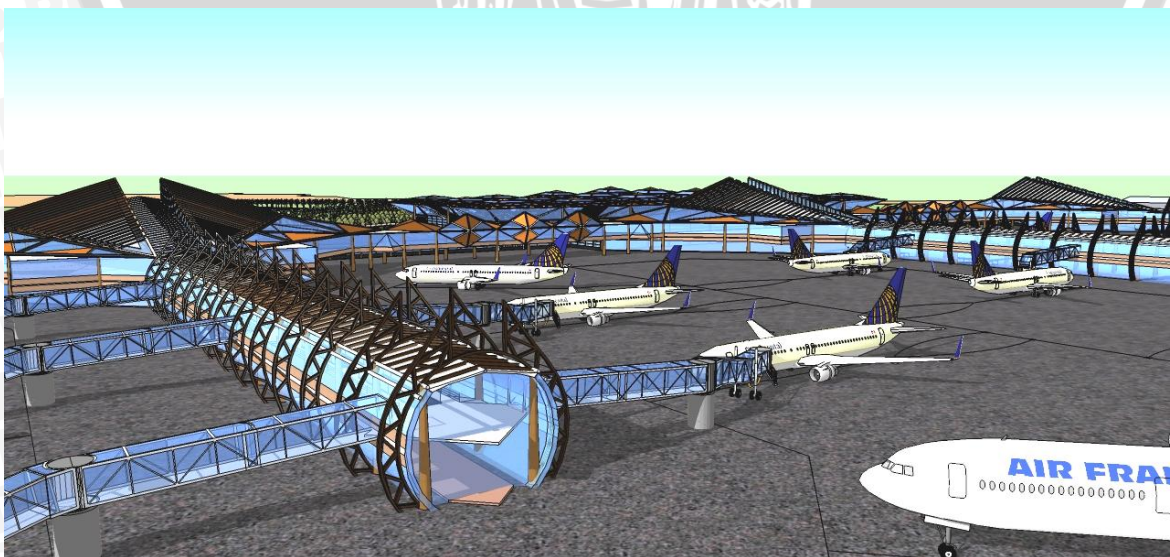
Potongan Terminal zona udara Alternatif 2
